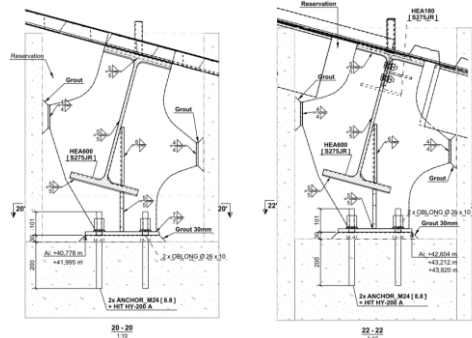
Desenho de projeto com detalhe de ligação da viga metálica à parede de betão armado
